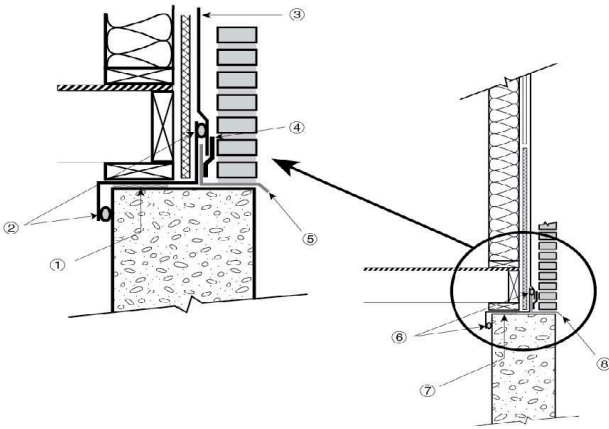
Détail de la base du mur de fondation pour la pose du produit :
